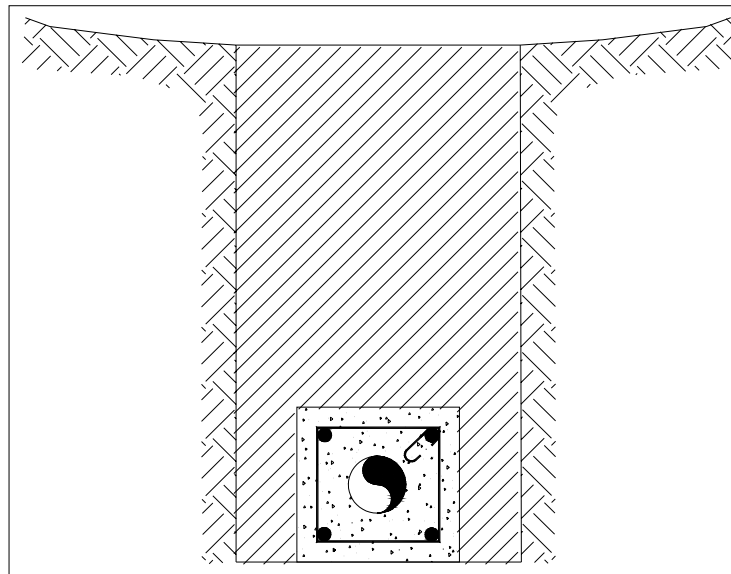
Tubería fierro galvanizado confinado en concreto armado en cruce de hondonada anchas.
